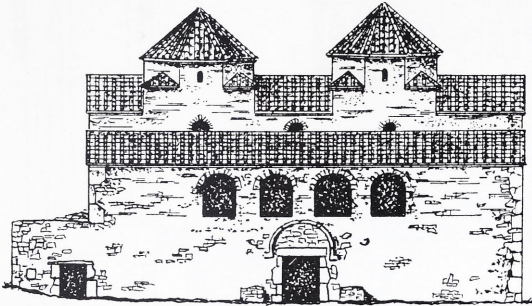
Gurdshani, Kirche Kwela Zminda, Ansicht von Süden mit rekonstruierten Galeriebögen
